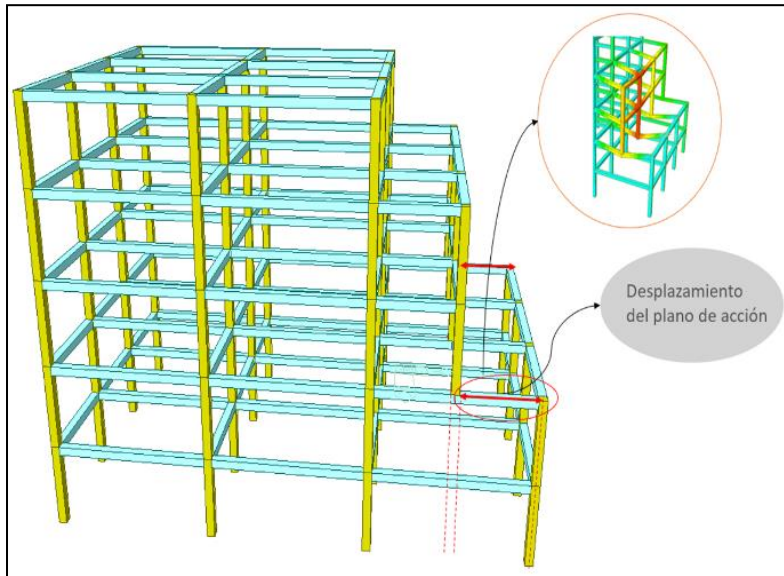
Estructura con desplazamiento del plano de acción de elementos verticales y su comportamiento.
